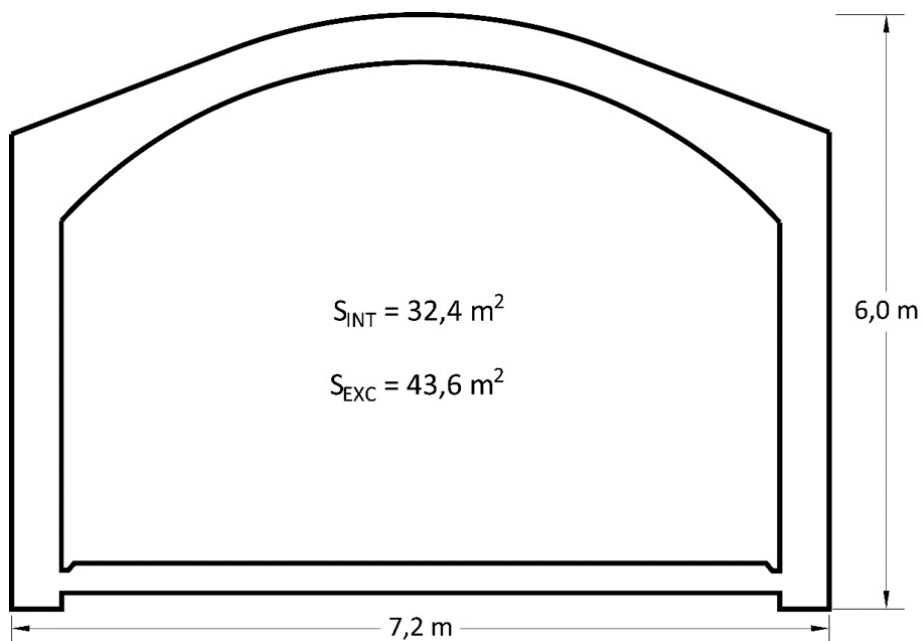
a.- Section type transversale de la Ligne Jaune (L-4).
